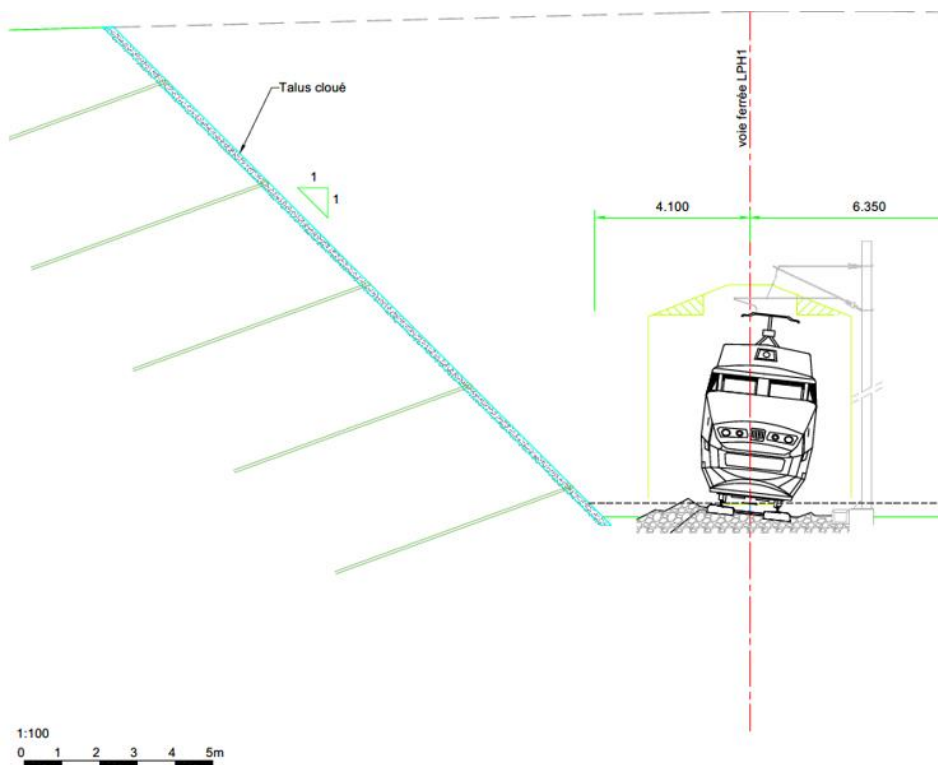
Vue en coupe de la rampe d'accès est du terrier (source : Egis, 2021)
